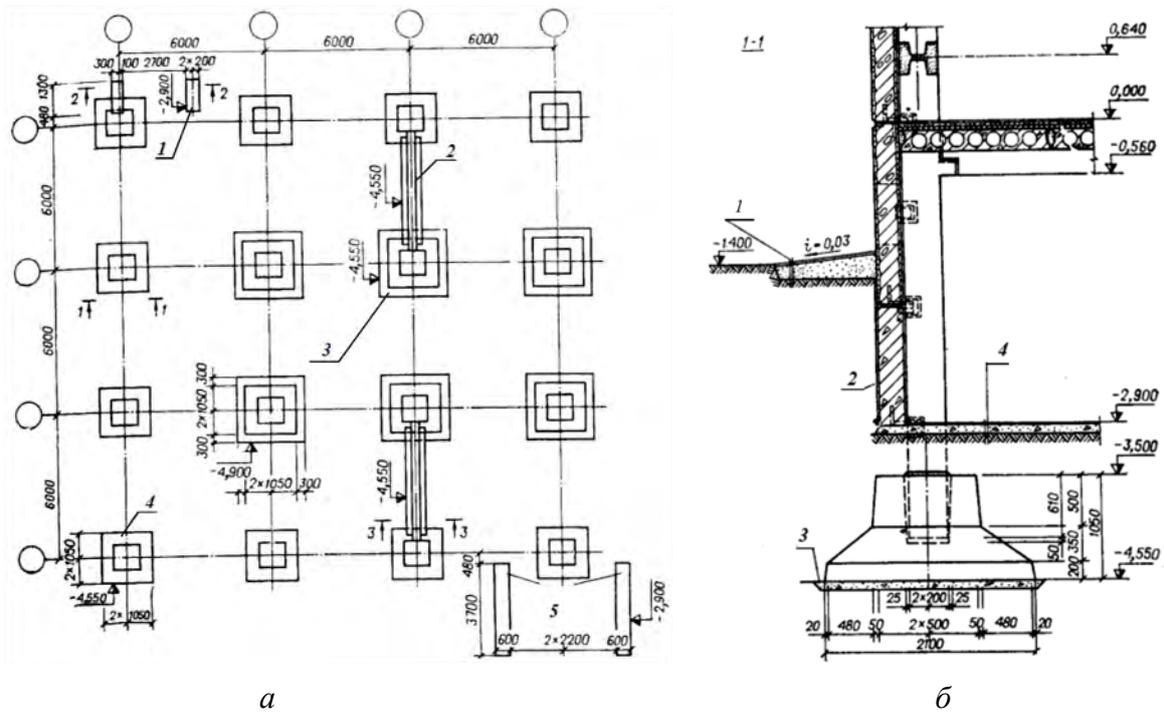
Отдельно стоящий фундамент под здание со связевым каркасом: *a* — фрагмент маркировочного плана: 1 — асфальт 20, щебеночное основание ≥ 150 , уплотненный грунт; 2 — обмазка горячим битумом (2 раза); 3 — подготовка из бетона марки 50; 4 — цементный пол 20, бетон марки 50, 100, уплотненный грунт; *б* — разрез: 1, 5 — фундаменты под крыльцо, монолитный бетон марки 100; 2 — фундамент диафрагмы жесткости монолитный бетон марки 100; 3 — фундамент ФМ1; 4 — фундамент Ф1
